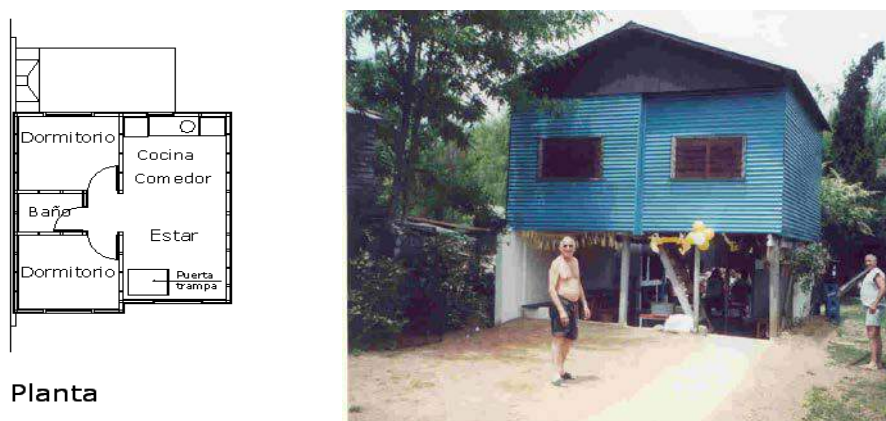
Vivienda en la riera de Quilmes – planta y vista
